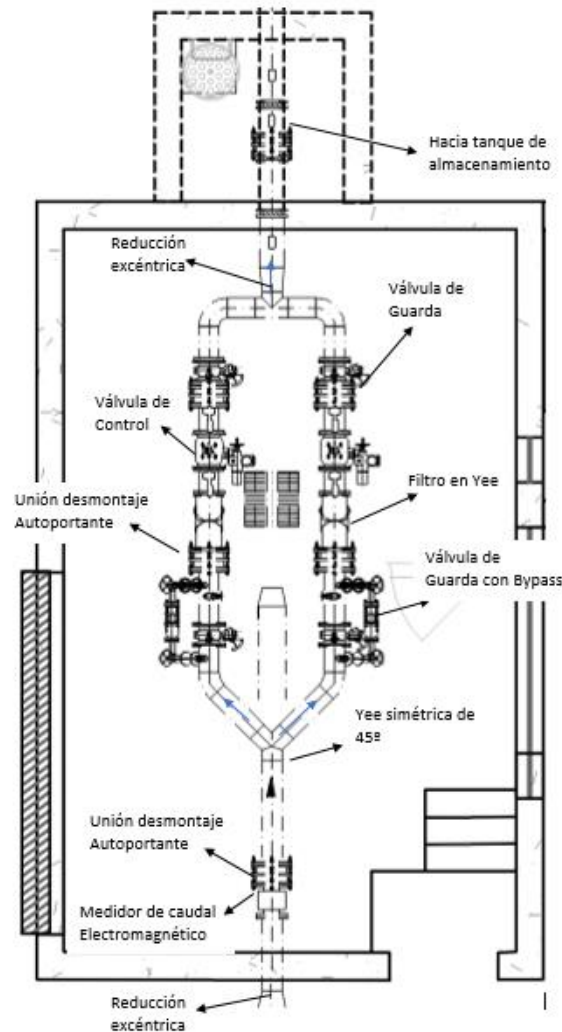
Vista en planta de la configuración tipo de una Estructura de Control (EDC)
